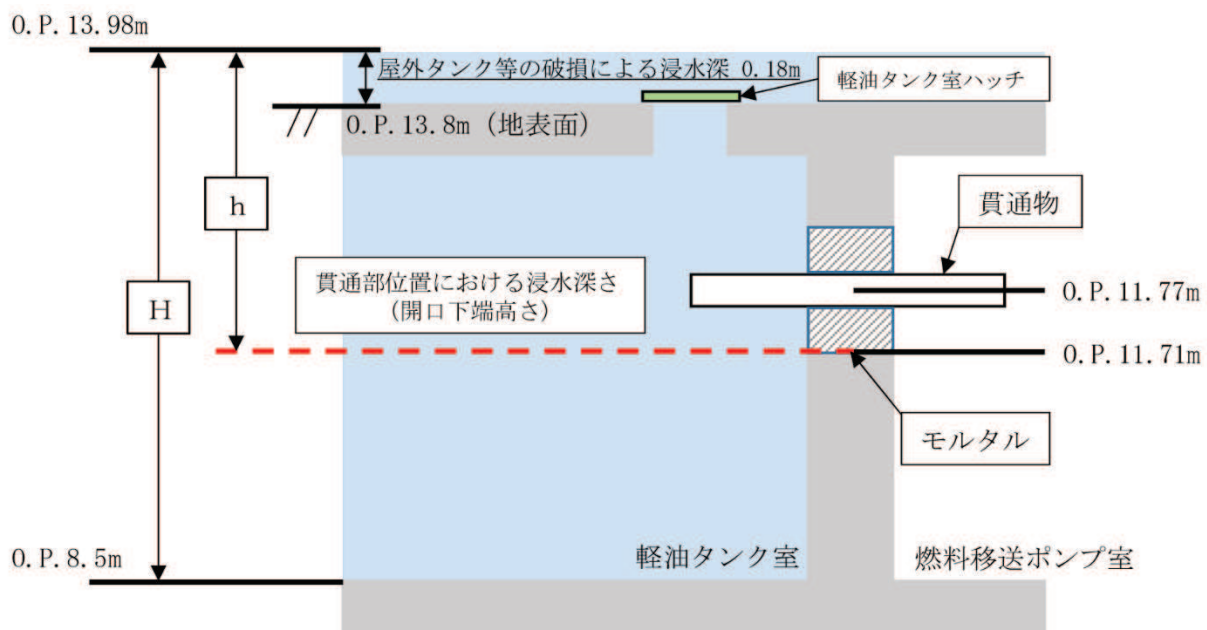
貫通部止水処置 (モルタル) に加わる荷重の概要
